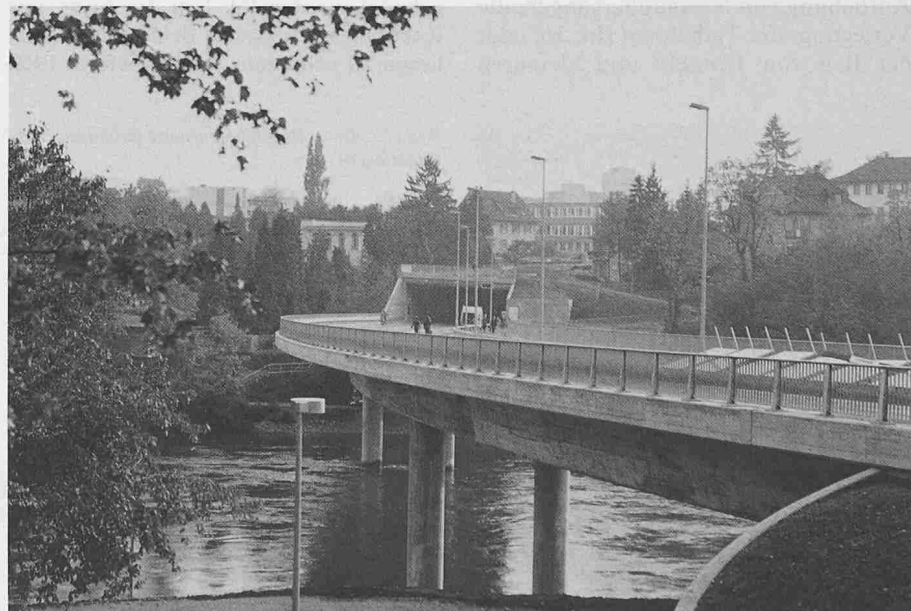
Umfahrung Brugg mit Aarebrücke B-031 und Nordportal des in offener Baugrube erstellten Tunnels
